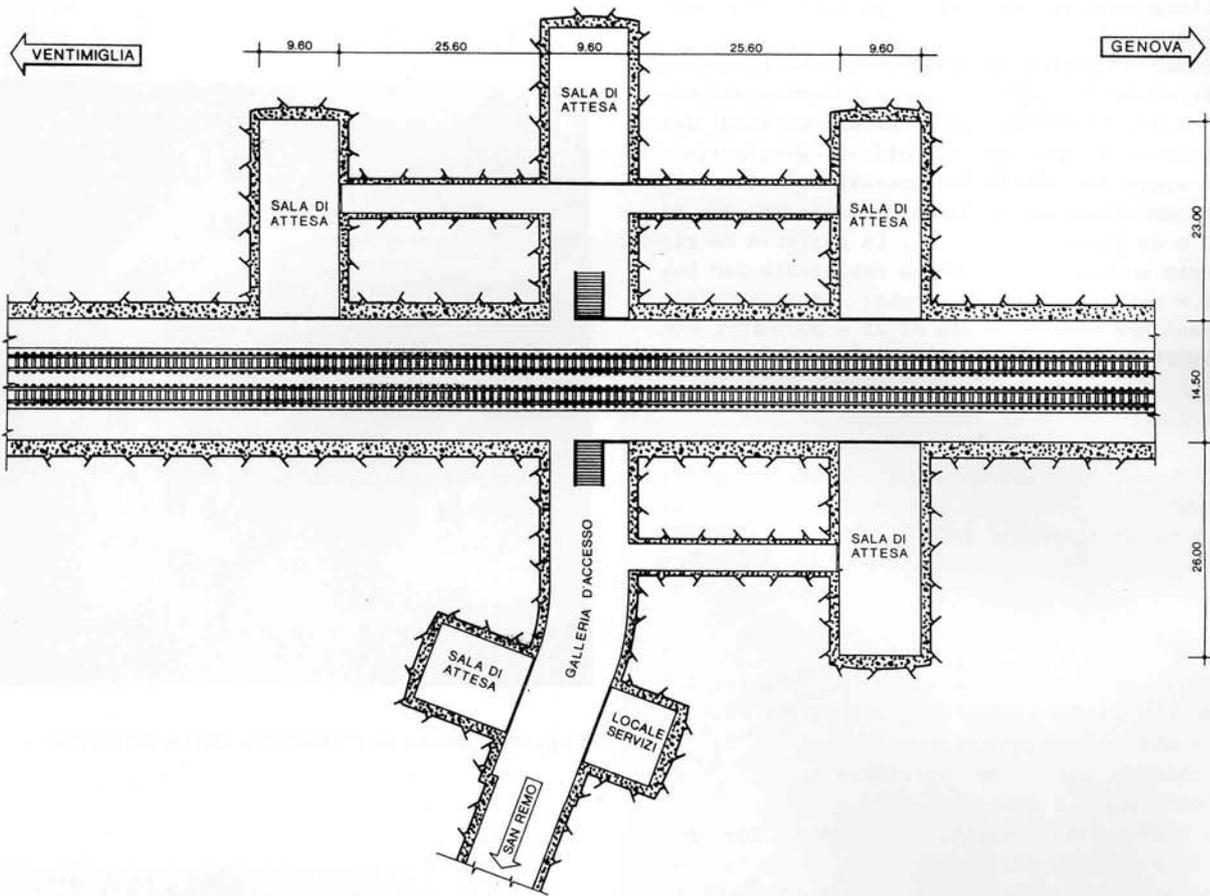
Planimetria della fermata in sotterraneo di San Remo
